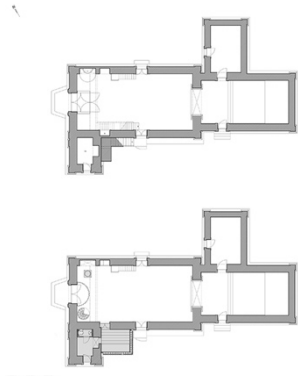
Planta do piso 0 da Igreja de Ataíde. Levantamento, em cima, e projeto, em baixo. Imagem do autor.
